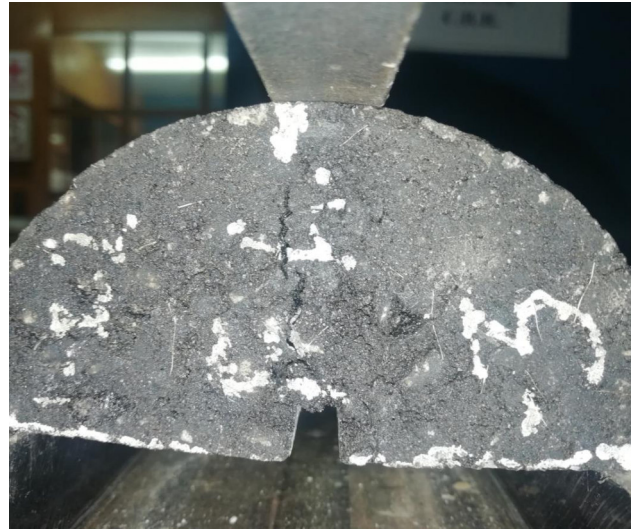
Falla en los especímenes modificados aplicando una carga.
